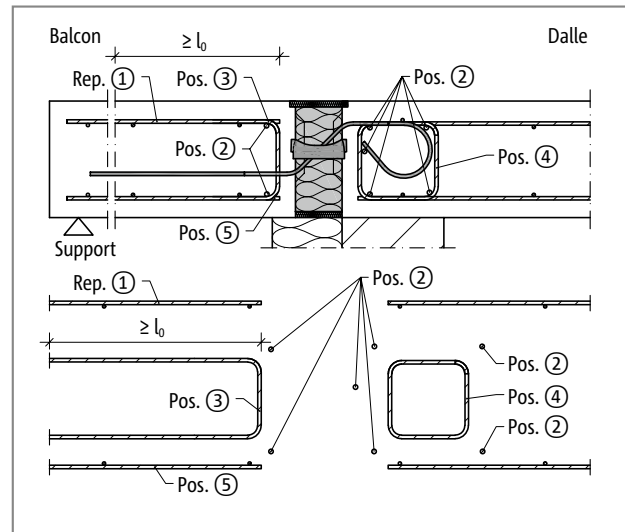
Schöck Isokorb® T Type Q-E-W-V : Renforcement sur site
